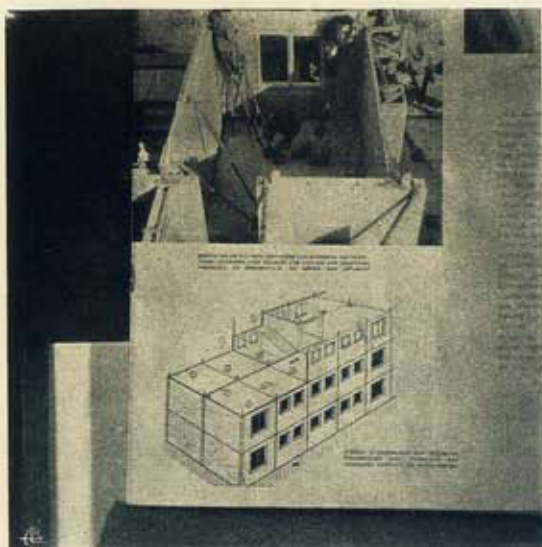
Colocação de escoras-tirantes. Em baixo, um esquema da samblagem dos elementos construtivos com indicações das cadeias de travamento assegurando o monolitismo.
